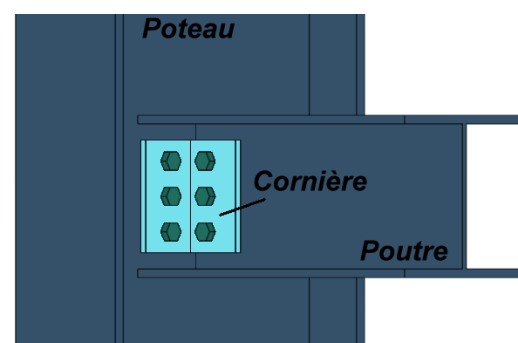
Articulation poteau-poutre par cornières boulonnées sur l'âme du poteau - perspective
